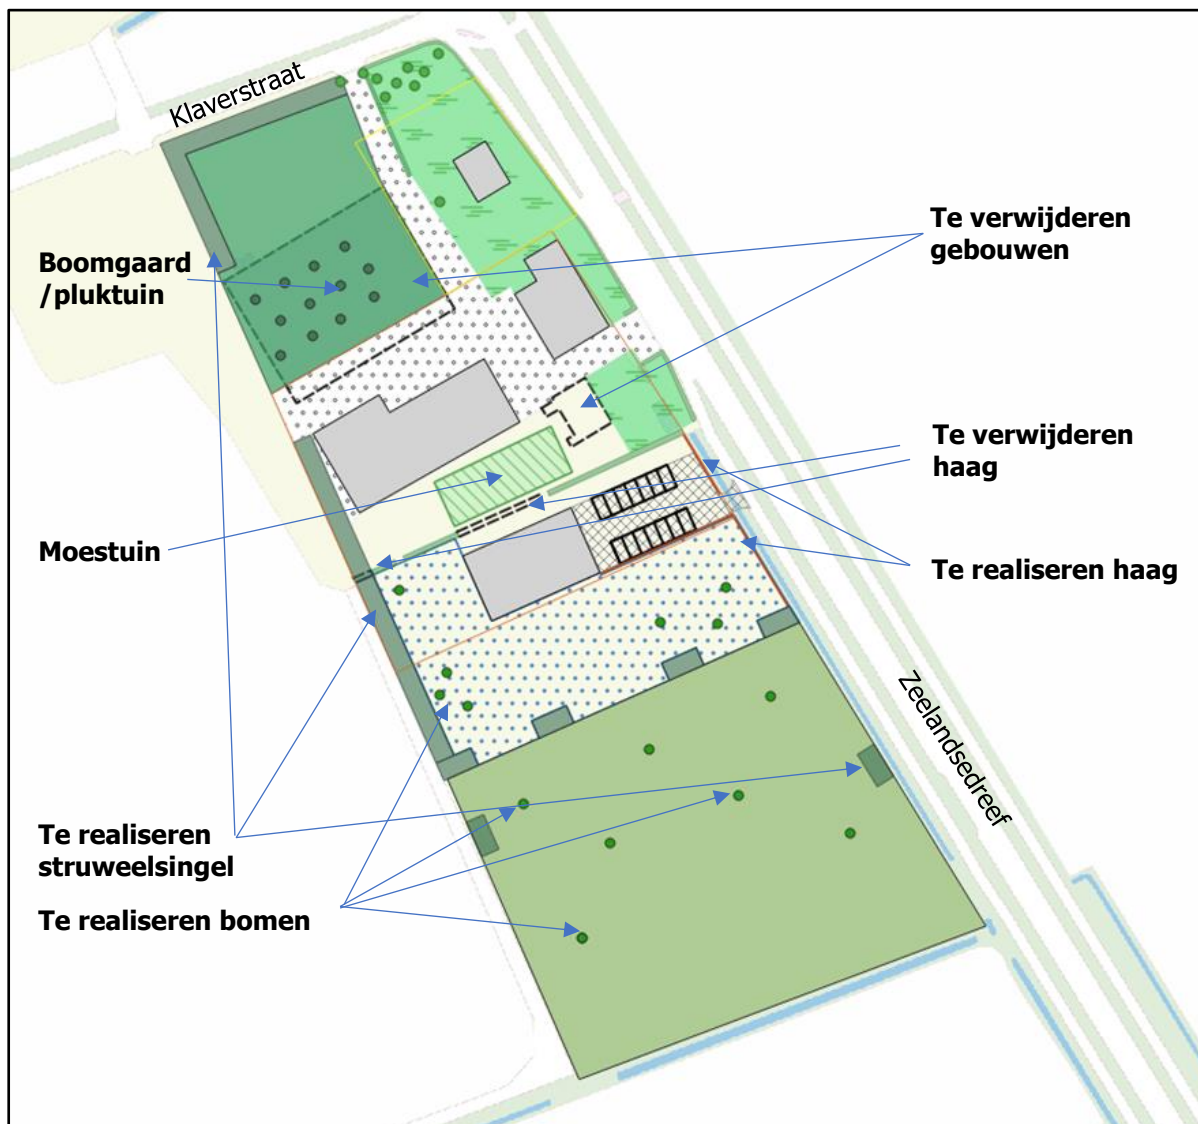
uitsnede landschappelijk inpassingsplan
